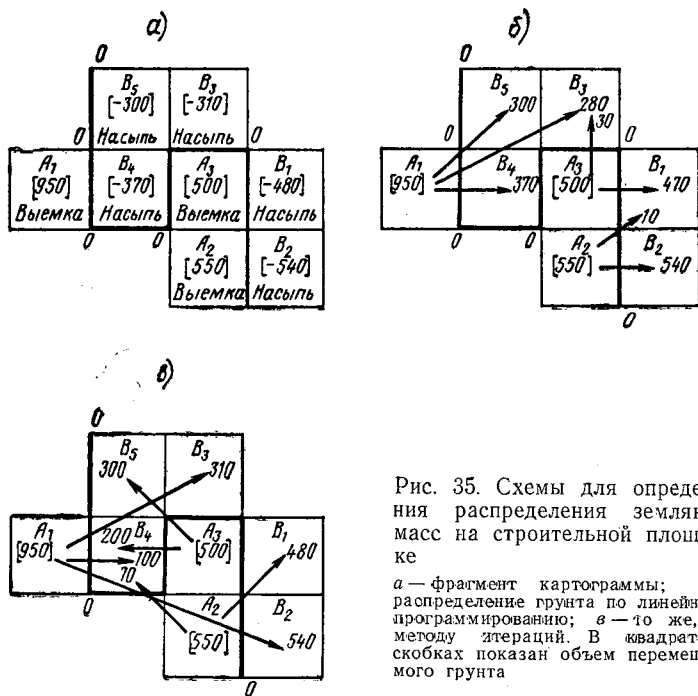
Схемы для определения распределения земляных масс на строительной площадке
